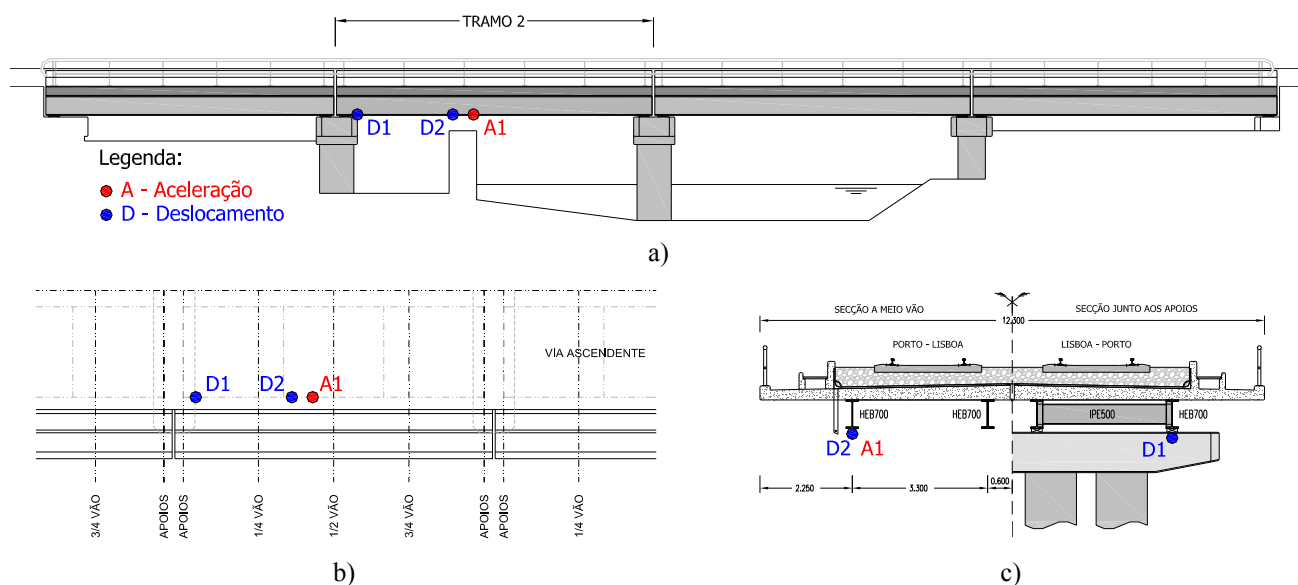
Pontos de medição do ensaio sob ação de tráfego ferroviário: a) alçado; b) planta; c) corte transversal tipo.
